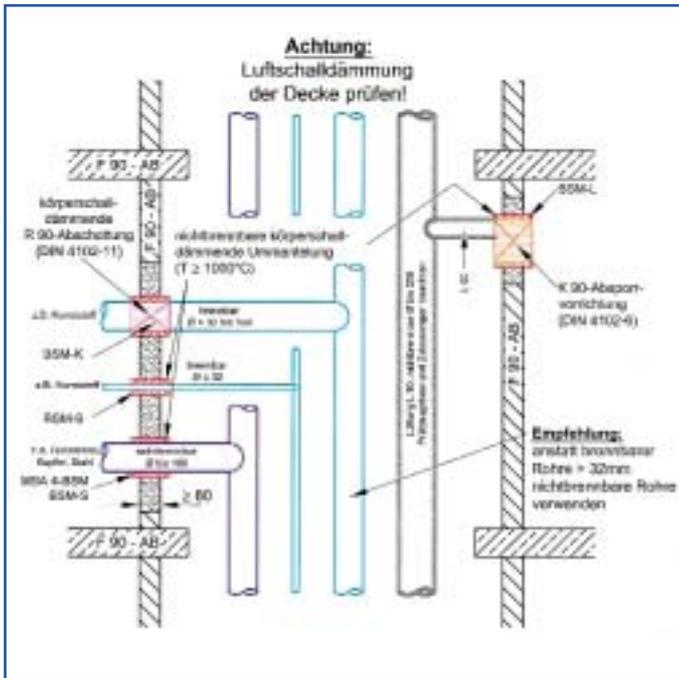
Mischinstallation von Sanitär- und Heizungsleitungen mit L90-Lüftungssystem im F90-Installationsschacht ohne Deckenverguß
